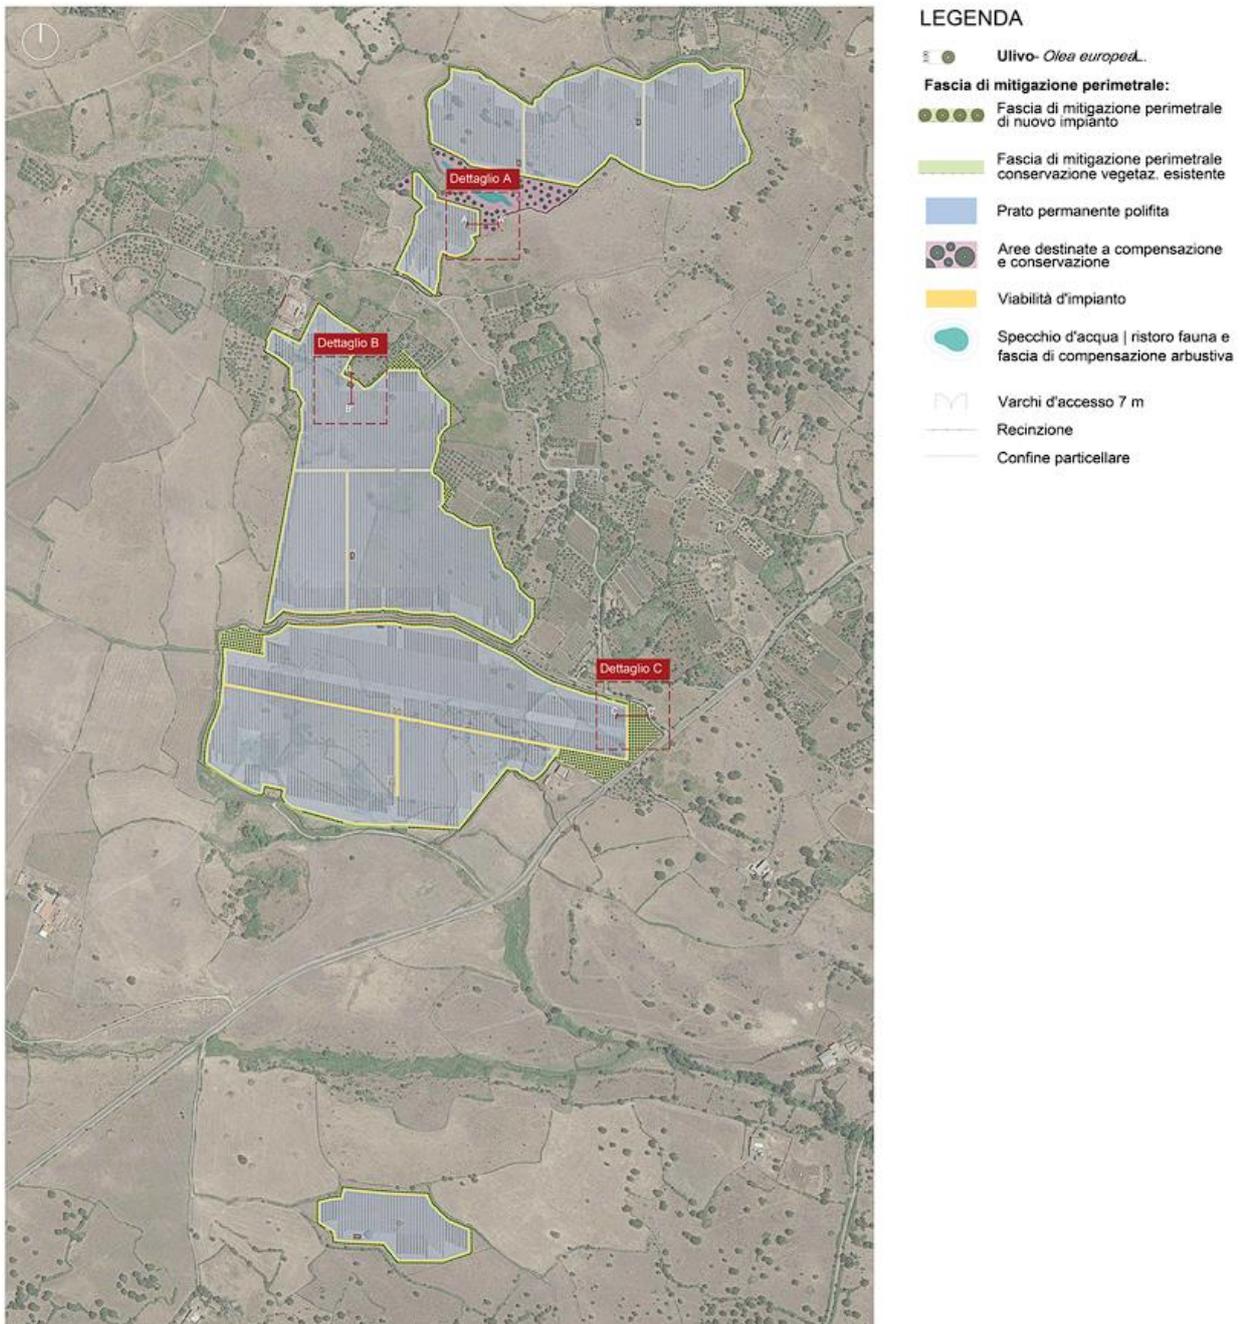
PLANIMETRIA SISTEMAZIONE A VERDE OPERE DI MITIGAZIONE (ESTRATTO DALL'ELABORATO GRAFICO SIN-PDT11)
